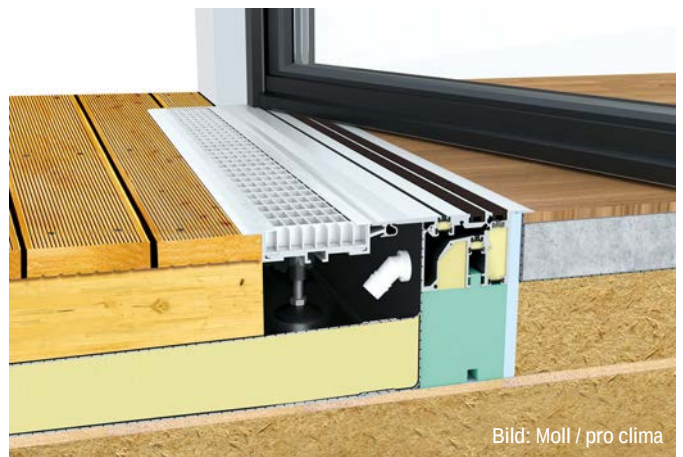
Sonderlösung: Barrierefreier Zugang zu einer Dachterrasse in Holzbauweise durch Einsatz einer Schwelle mit Magnetdichtung und integrierter Entwässerung.
